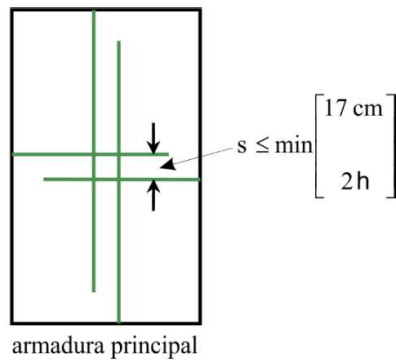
Espaçamento máximo da armadura de flexão – barras alternadas
